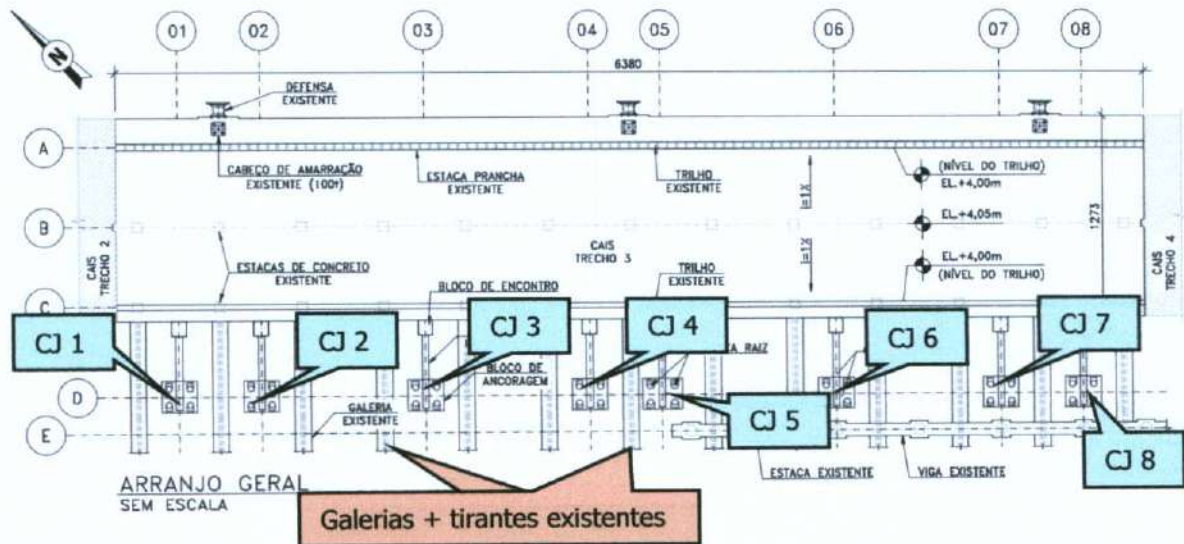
Novos sistemas de ancoragem – planta (segmento 3)
